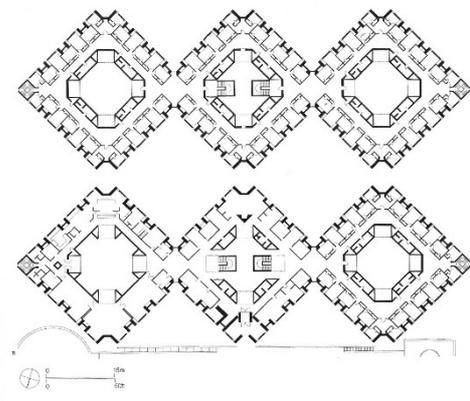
e 56 | Planta e volumetria do Erdman Hall Dormitory [McCarter]
